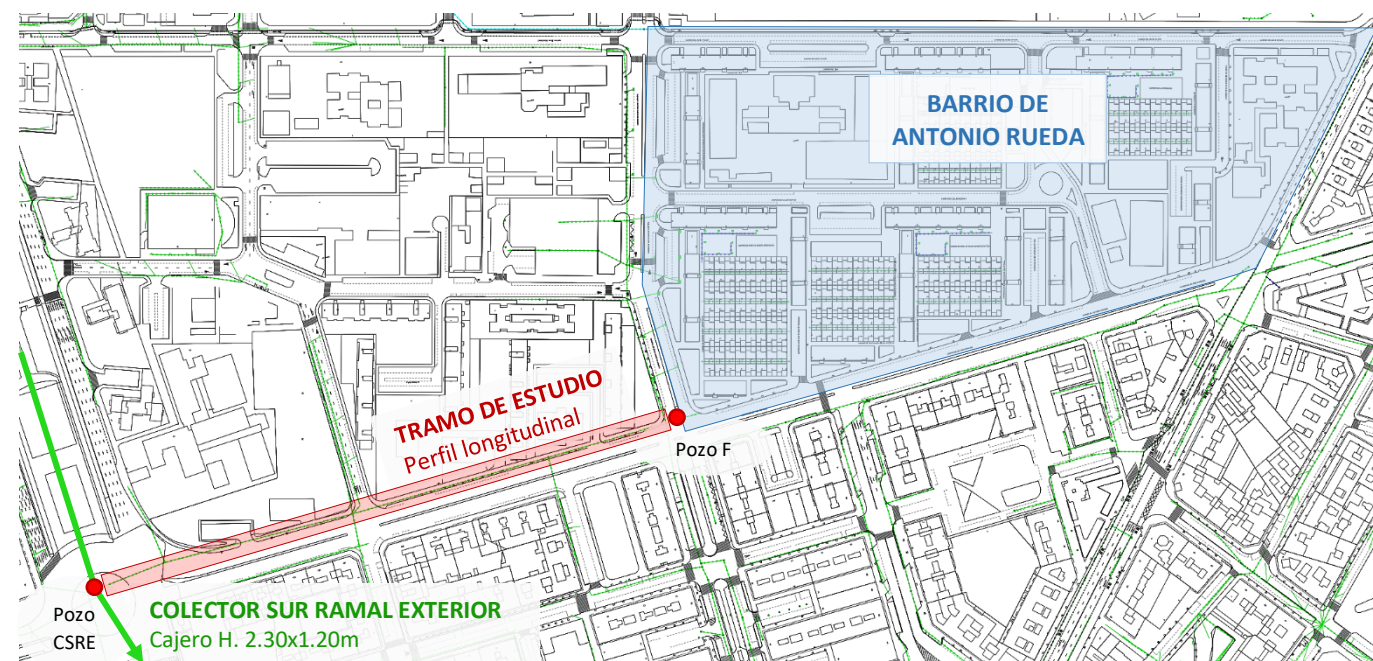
Esquema en planta para el estudio de la opción A. Fuente: Elaboración propia.
